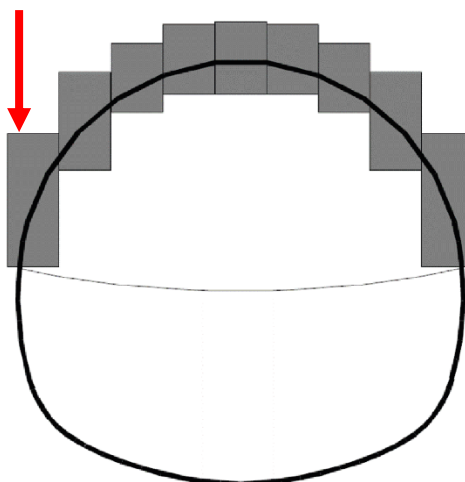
Aplicação de jet grouting na frente de escavação do túnel como técnica de melhoramento do solo
